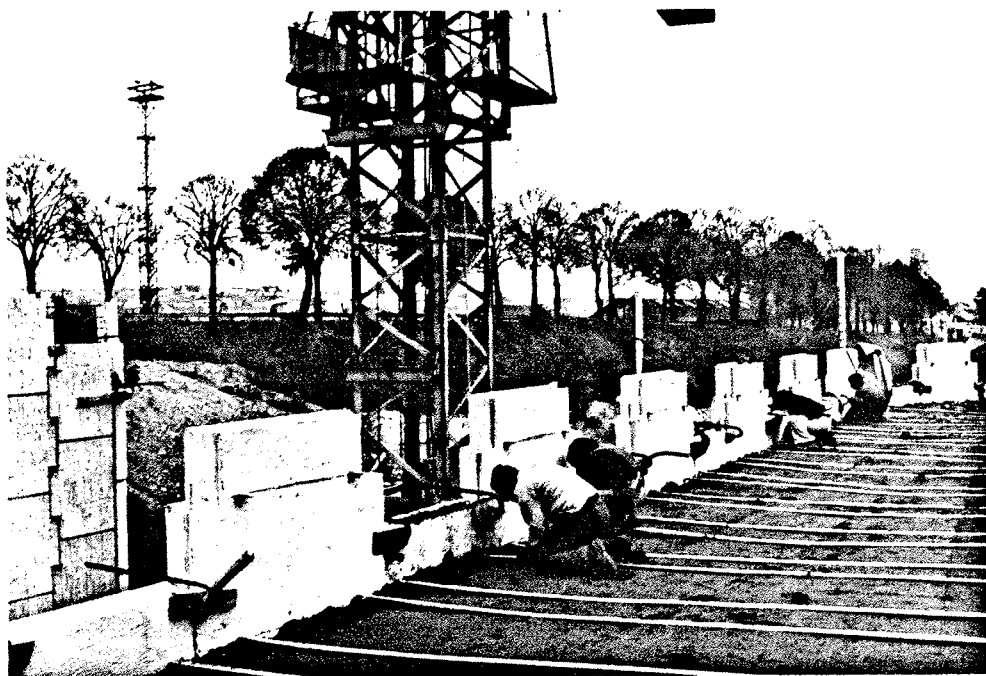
Bygging av støttemur, Vidalprinsippet, hvor hovedelementene er betongpaneler, armeringsbånd og bakfyllmasse av grus.
